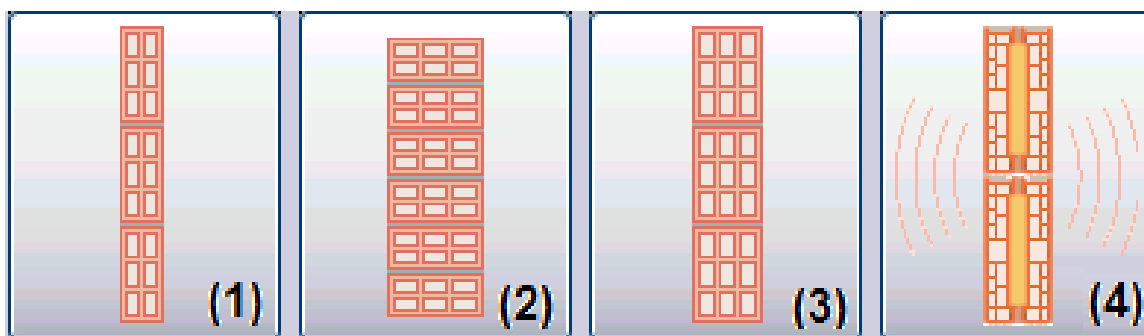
Tijolo cerâmico furado duplo longitudinal (1), duplo transversal (2), triplo (3) e painel *sandwich* (4) [37]
